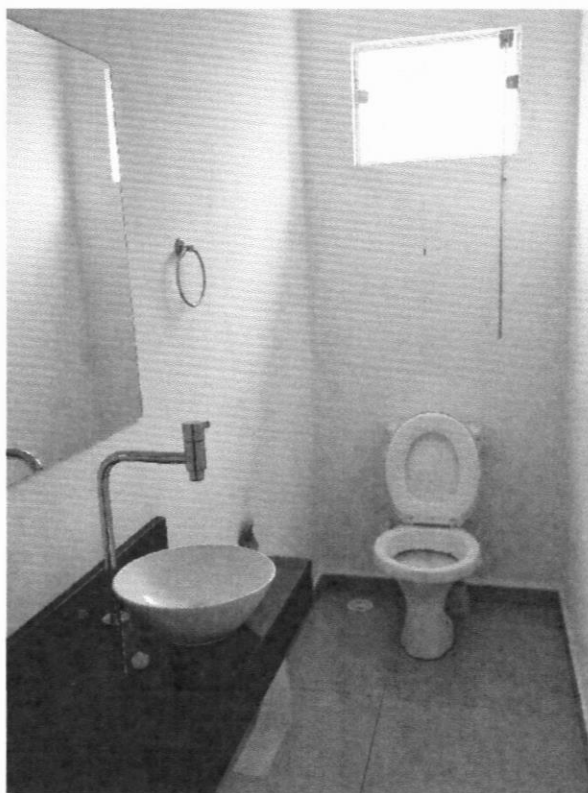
Vista do banheiro da sala de treinamento do refeitório
